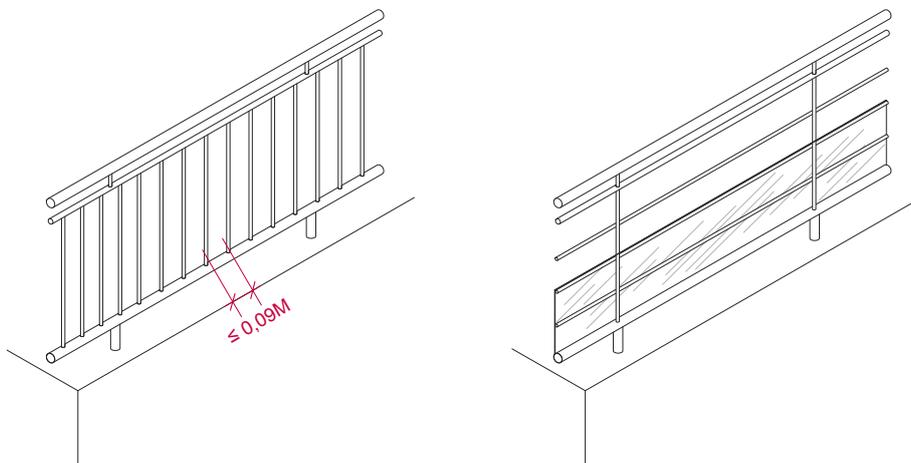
Entraxes des garde-corps et dispositif empêchant d'y grimper
